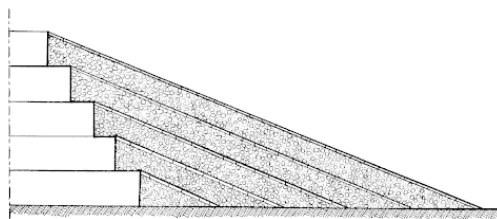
Разрез насыпи (пандуса), использовавшейся при строительстве пирамиды (по Круну)
